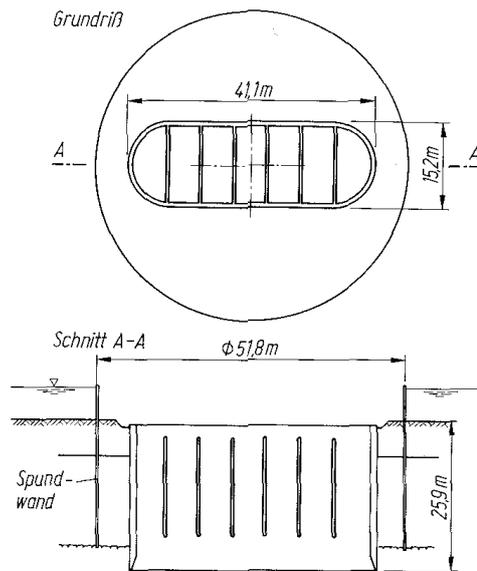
Beispiel für einen offenen Brückensenkkasten mit Aussteifungswänden [2]
